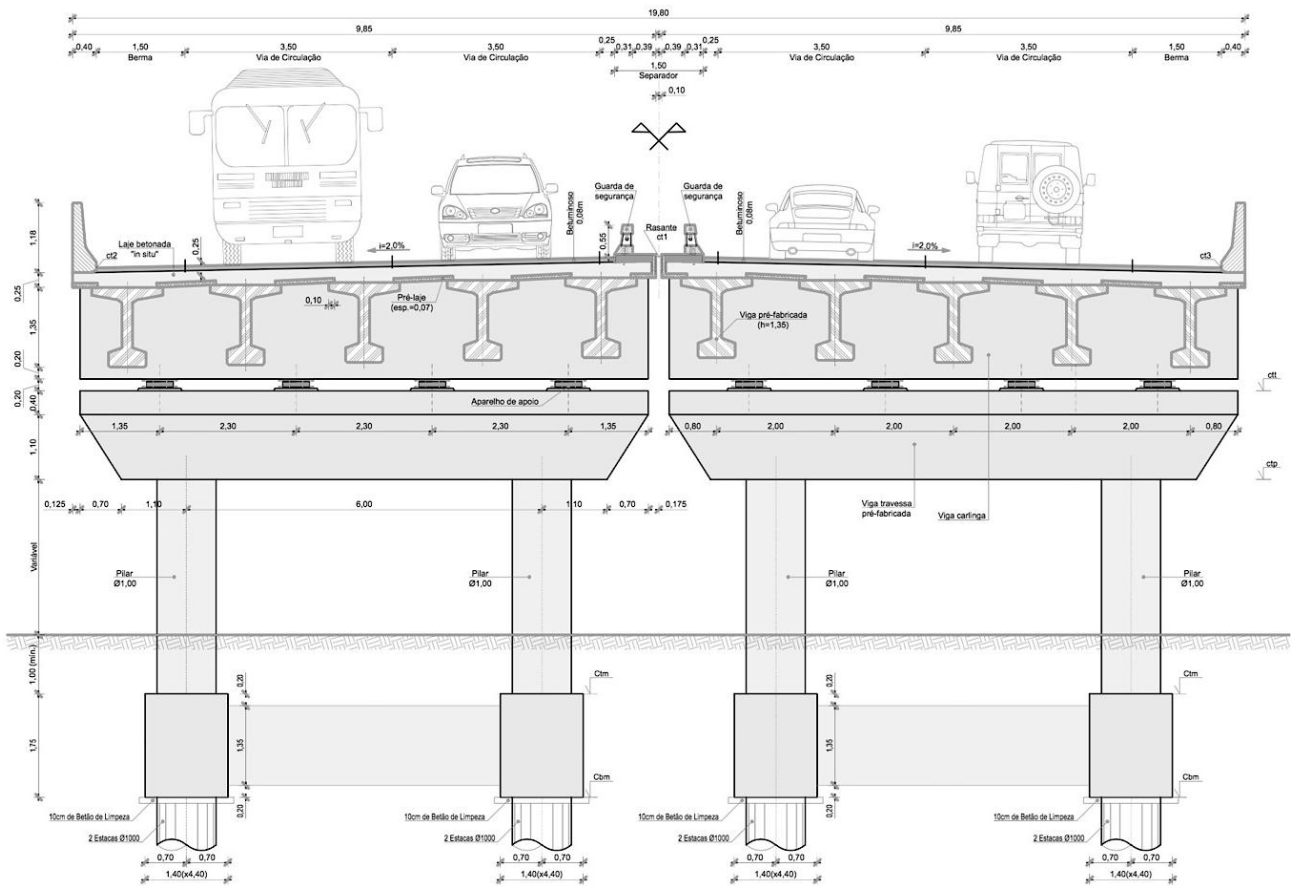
Corte transversal tipo do tabuleiro [29]
